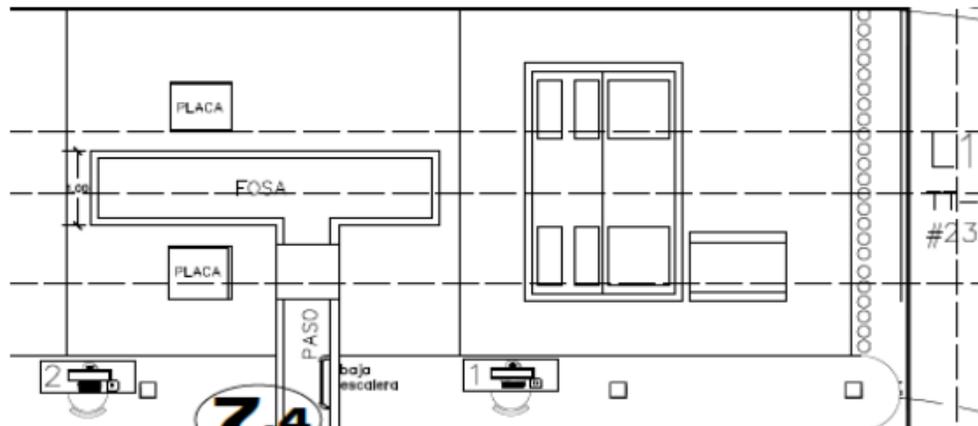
Línea de Inspección Físico-Mecánica dimensiones.
